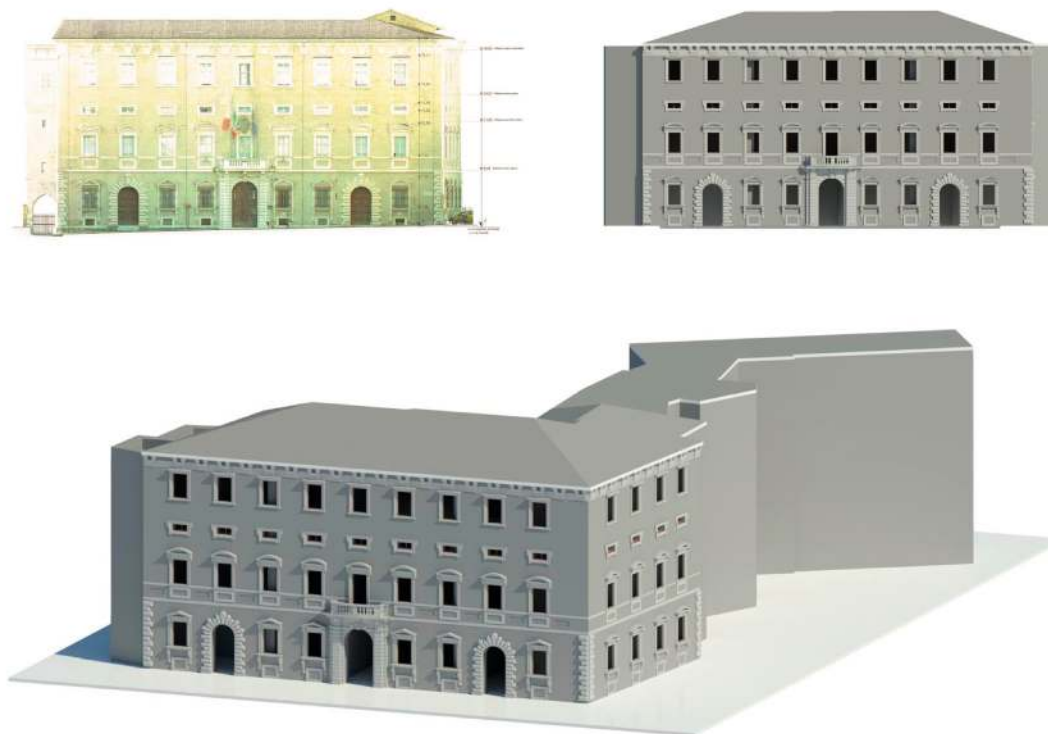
Modellazione HBIM di Palazzo Ferretti, confronto tra prospetto da rilievo TLS e prospetto da modello, vista assonometrica da Revit con ray-tracing
